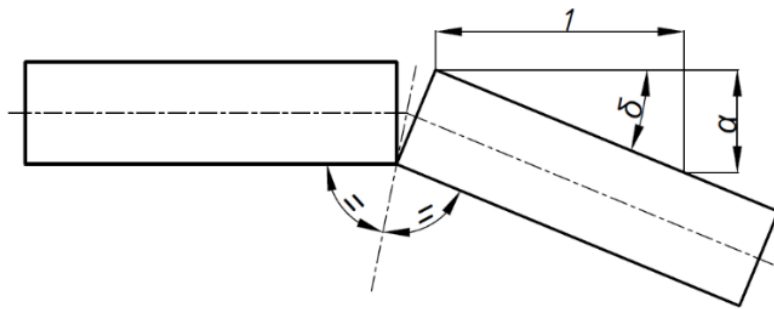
Угловое отклонение в соединении стальной муфтой
